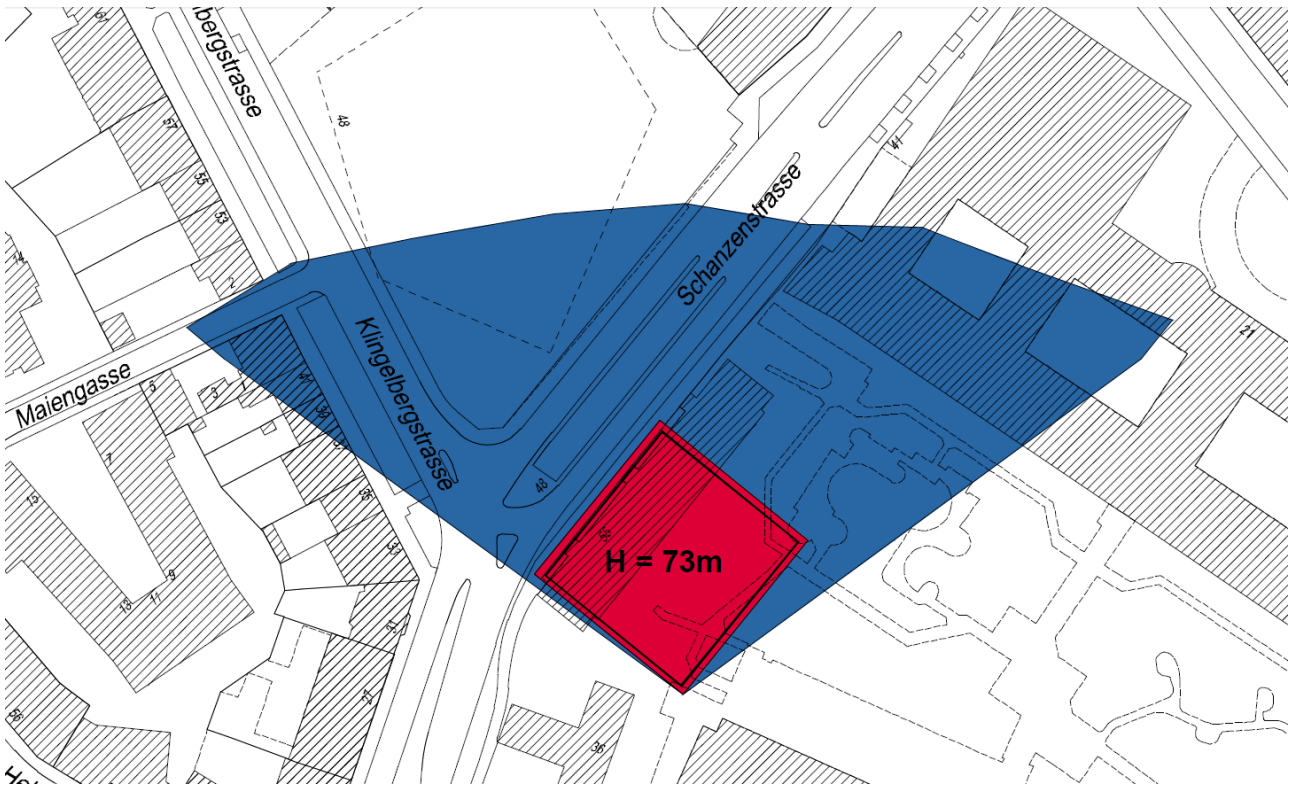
Zwei-Stunden Schatten des geplanten Hochhauses (Höhe: 73 m) des Klinikums 3 (Plan genordet)
